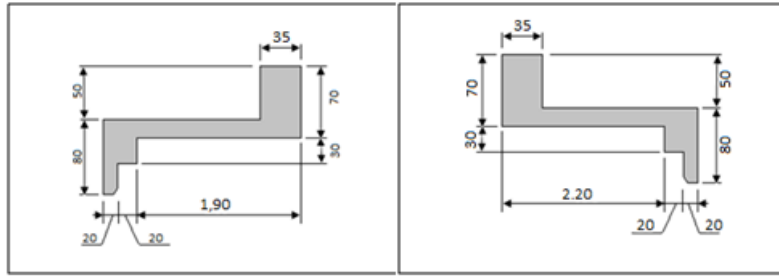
Coupe transversale du trottoir avec la corniche.
